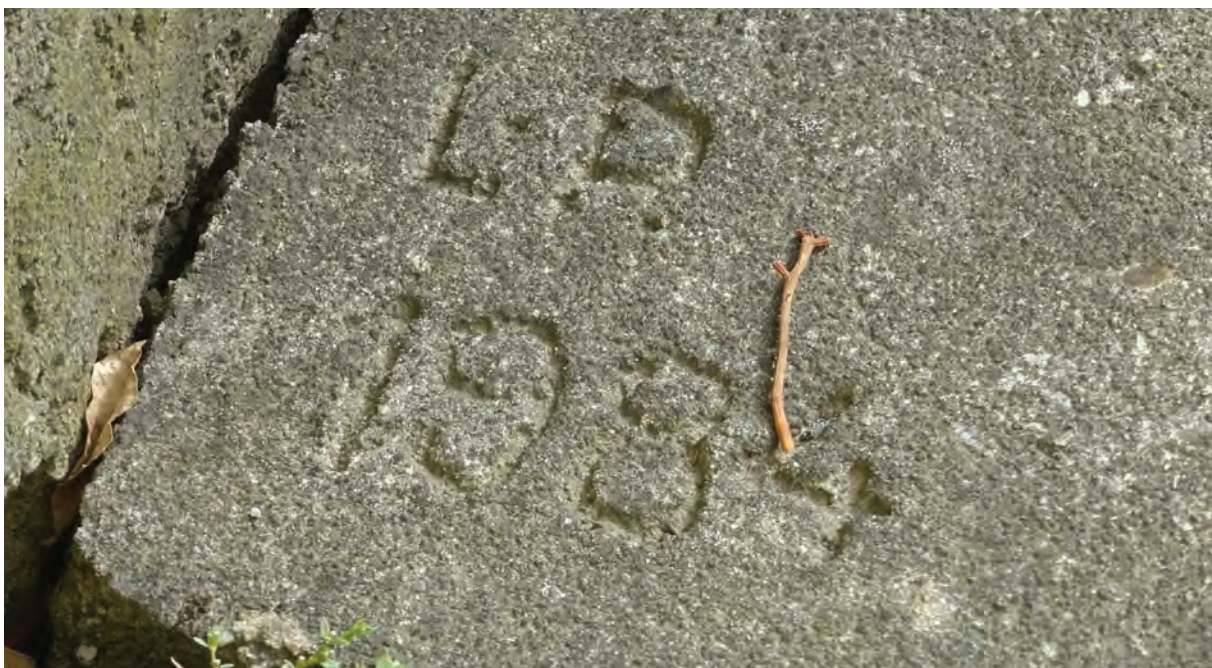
Haus Nazareth, Treppenanlage östlich des Gebäudes
